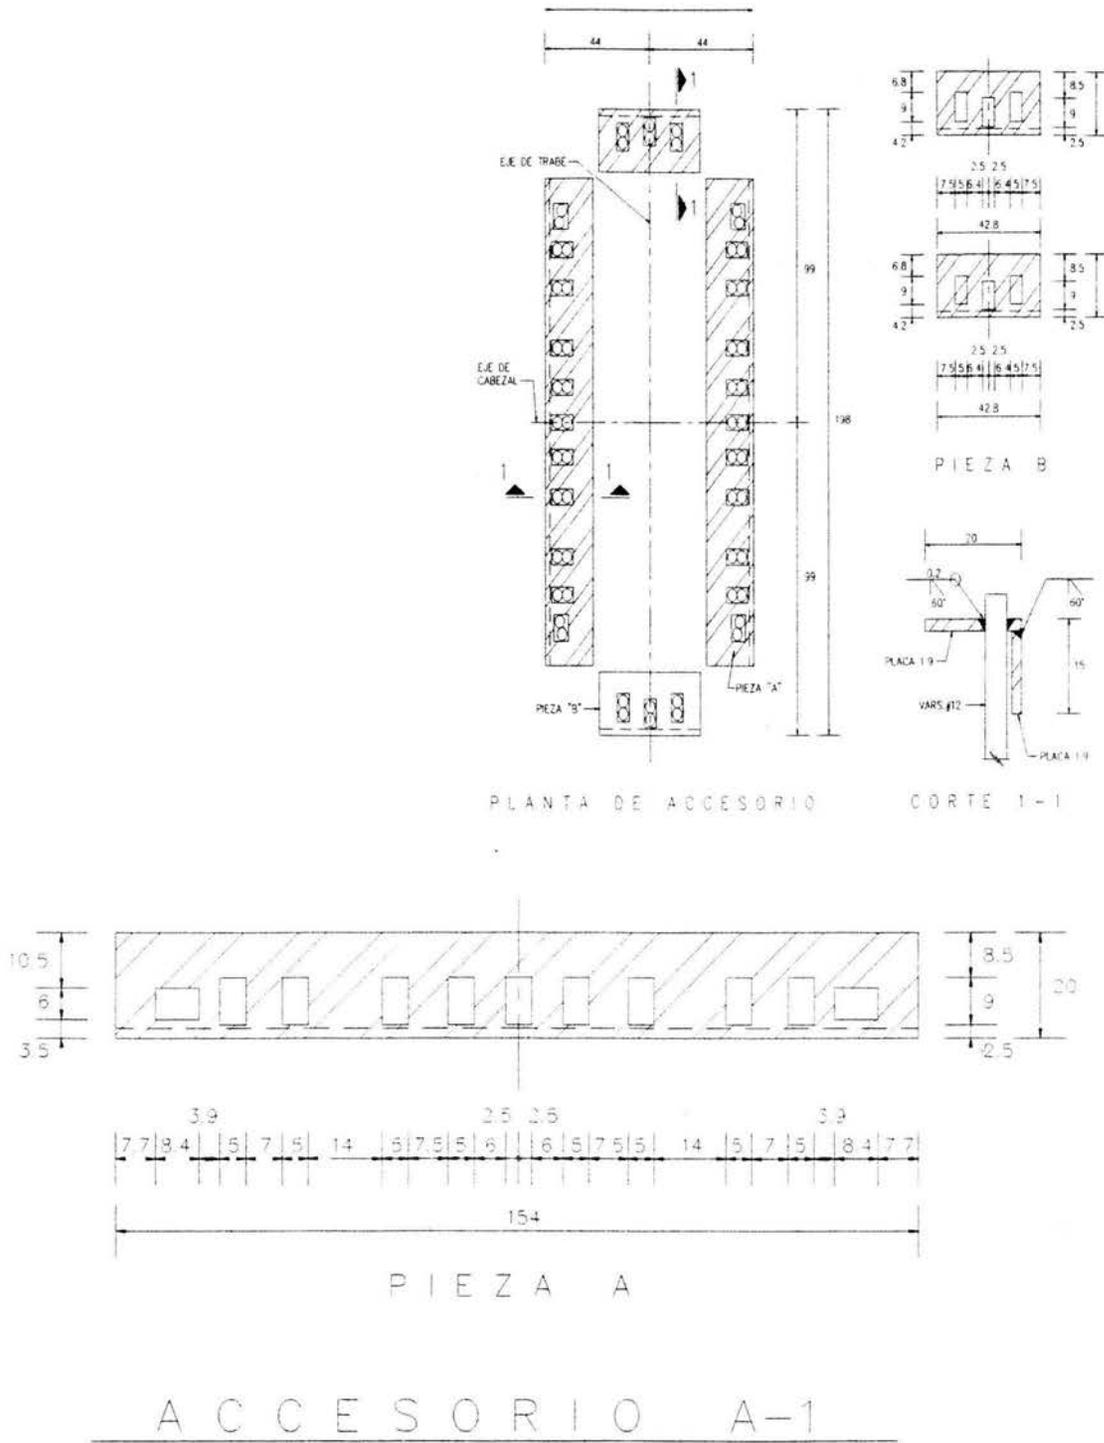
Detalle de refuerzo de trabe y columna
